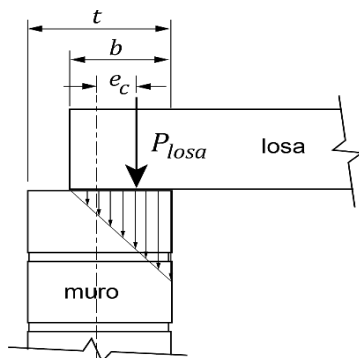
Excentricidad de la carga vertical en muros extremos
